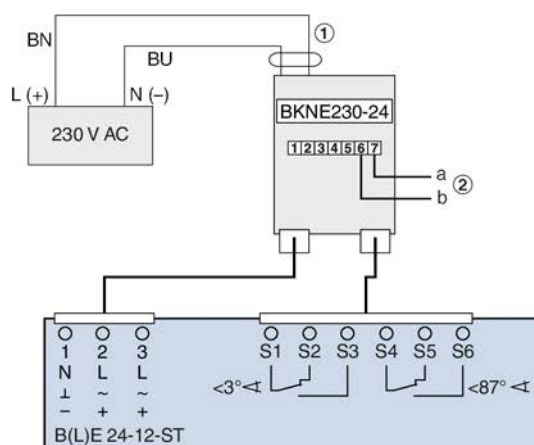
Exemplo de cablagem para o acessório B24BKNE
